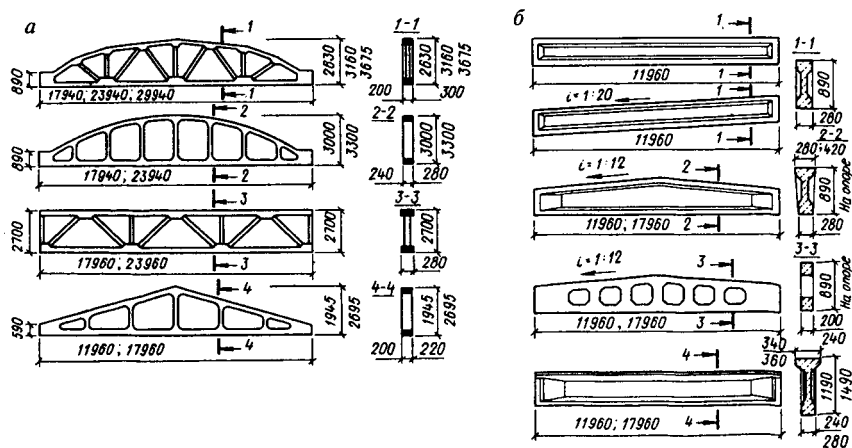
Виды железобетонных ферм (а) и балок (б)
